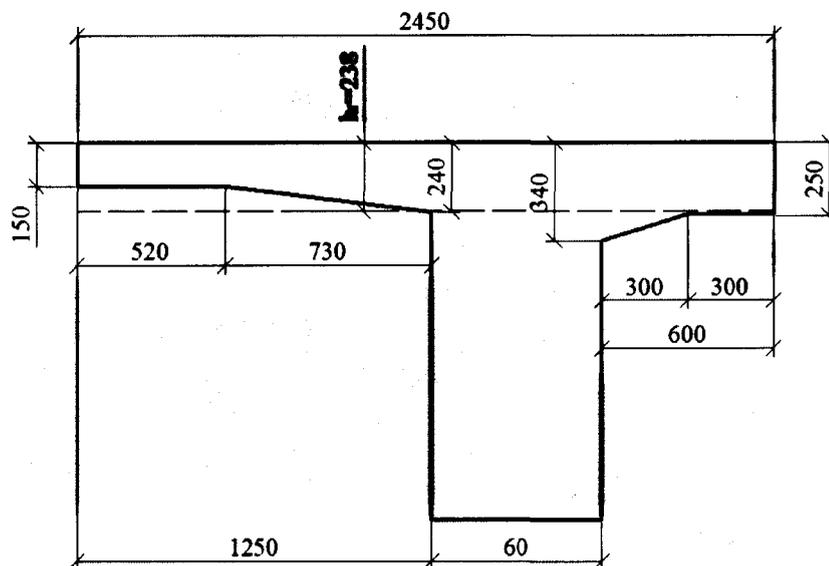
Схема для определения основных геометрических размеров расчетного сечения
